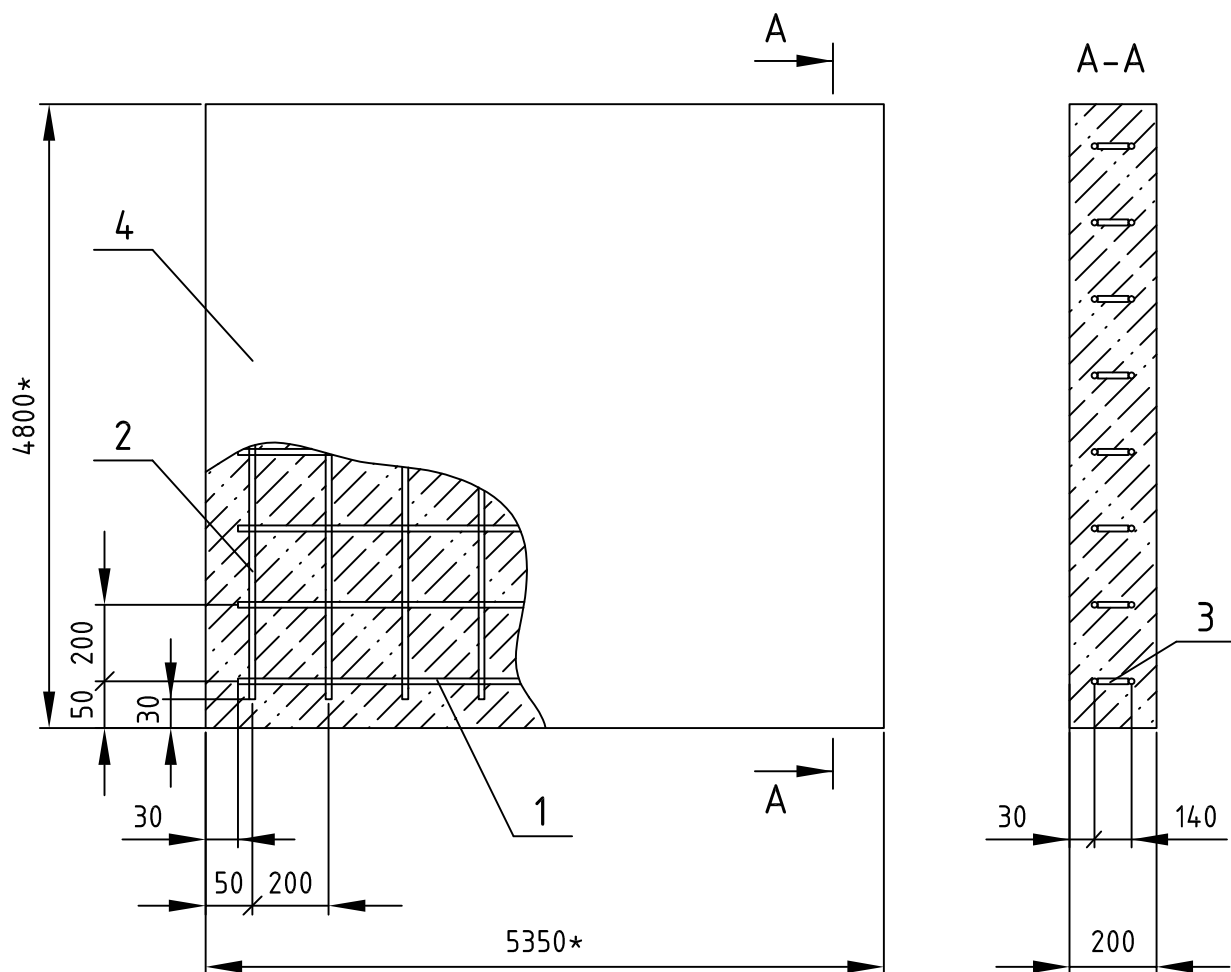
Железобетонная плита для установки объемного кабельного прямка и КТП-БК
